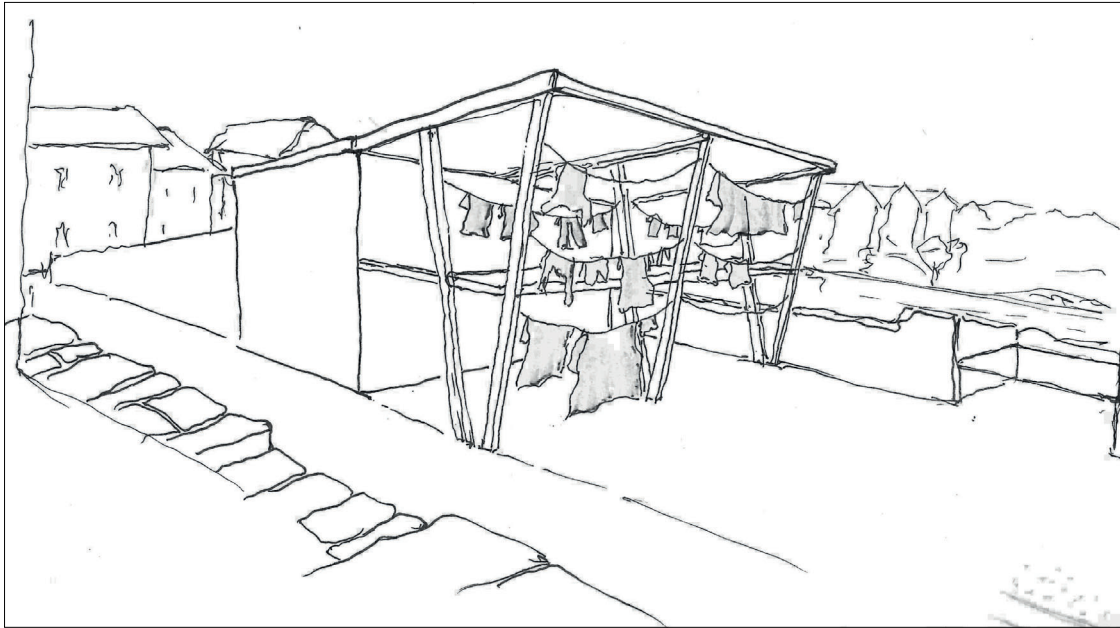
Skizze der Dachstruktur mit „Wäscheleinen-Fassade“.
